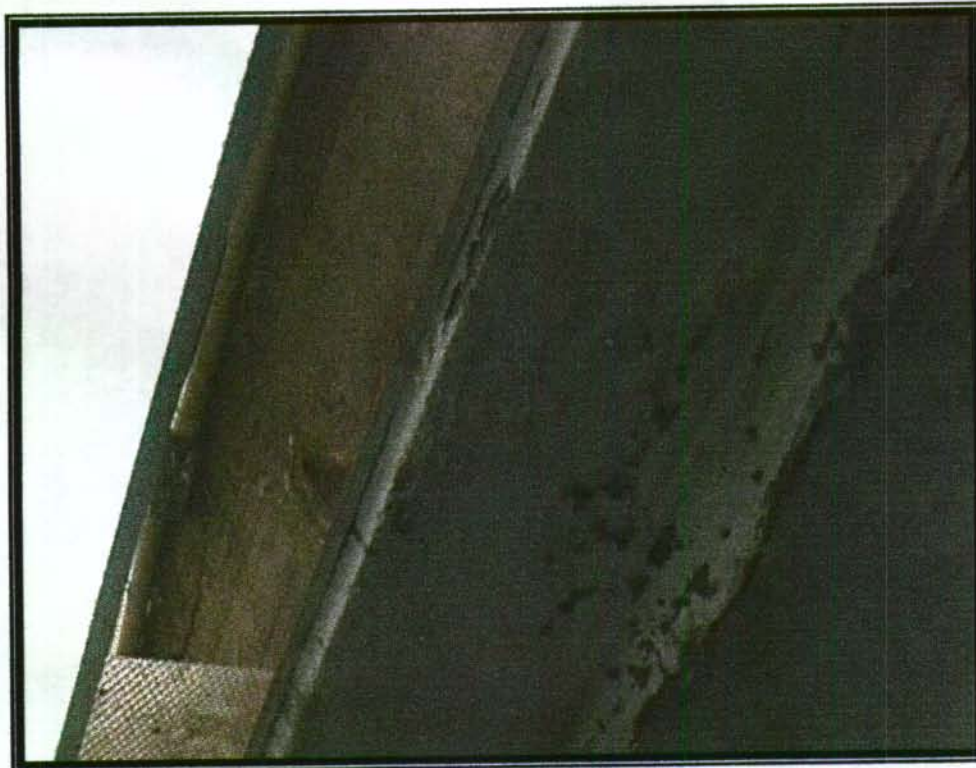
DETERIORO BAJO PLACA DE SEGUNDO PISO – ZONA MUROS DE CARGA
